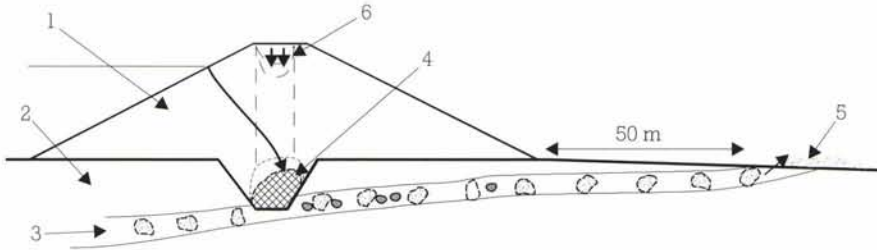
Coupe schématique du barrage d'AURENSAN et de sa fondation.
